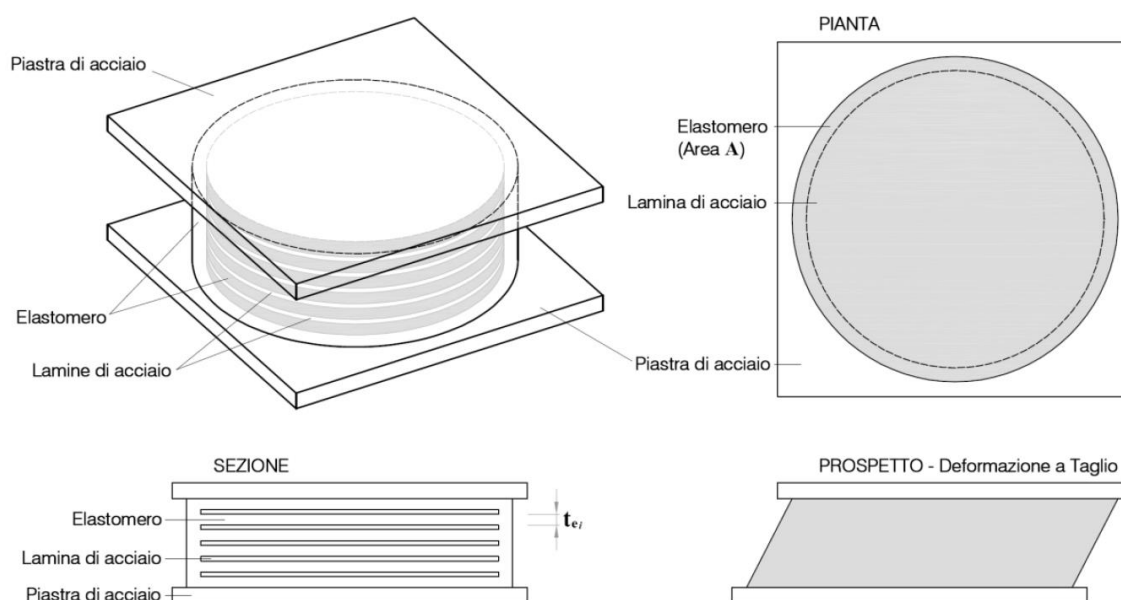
Schematizzazione di un isolatore elastomerico convenzionale (*SREI*). In basso a destra la caratteristica deformazione del dispositivo per scorrimento dei piani di appoggio (Fig. 4.2 (a)).
